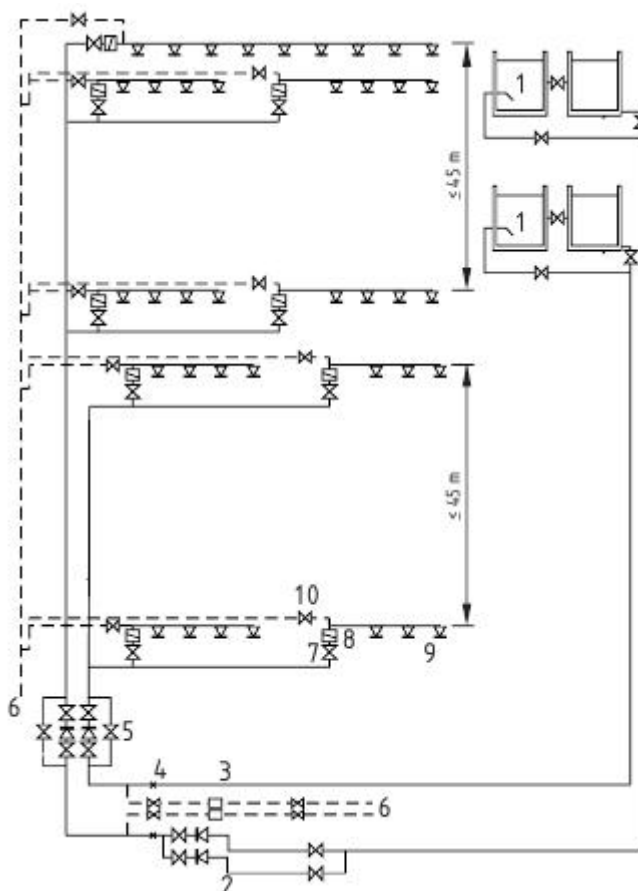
Типовая схема системы, которая защищает высотный дом, с напорными резервуарами и насосами-повысителями
